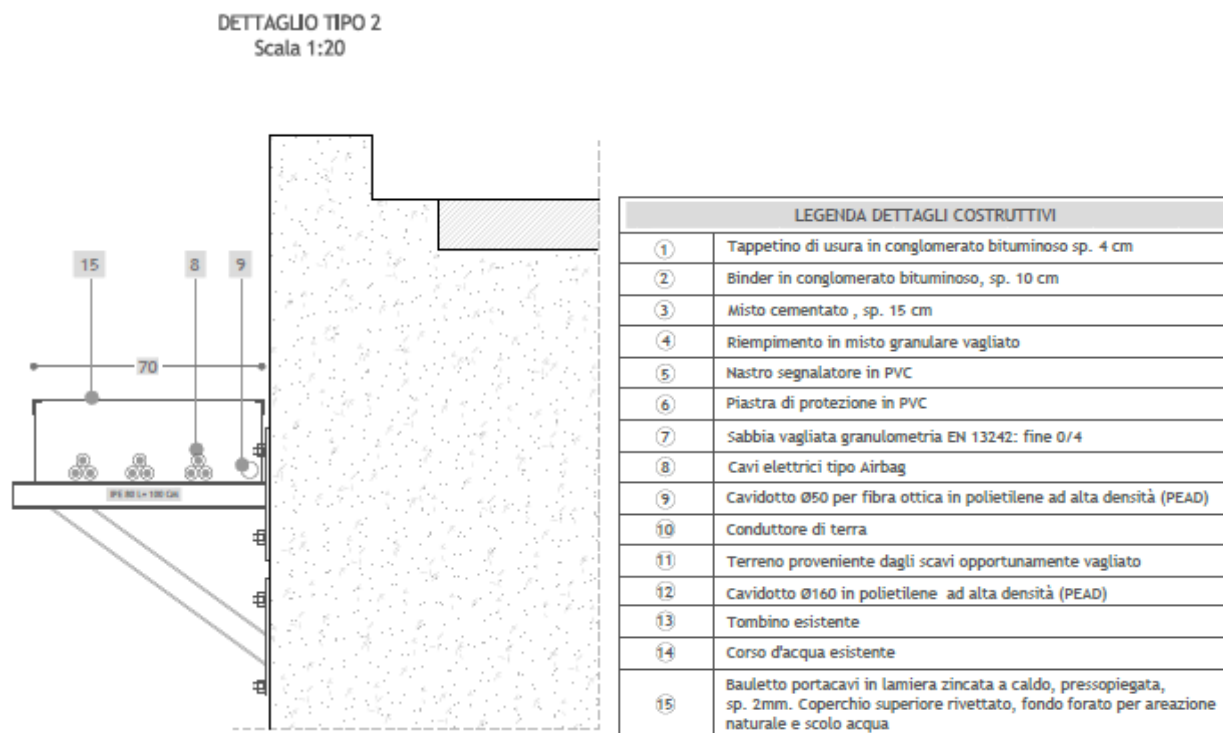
Attraversamento tipo 2 – Attraversamento di un ponte
